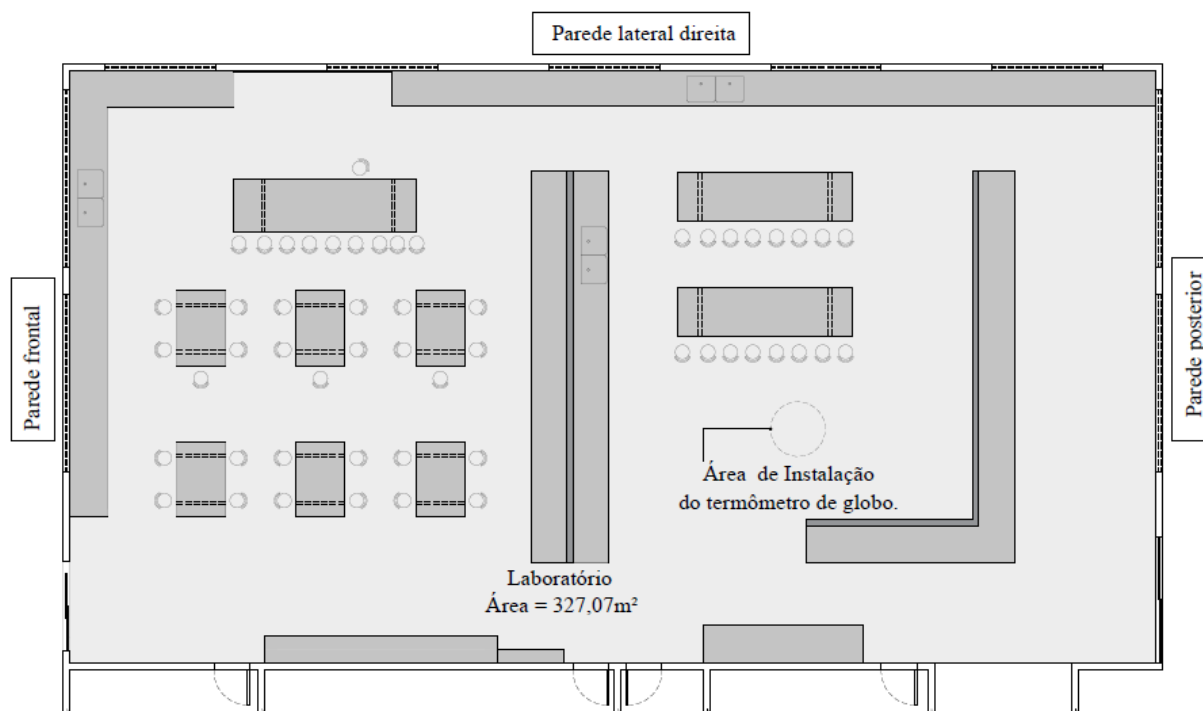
Localização em planta baixa do Laboratório de Concretos e Solos especificando o ponto de instalação dos instrumentos, e nomenclatura das paredes.
